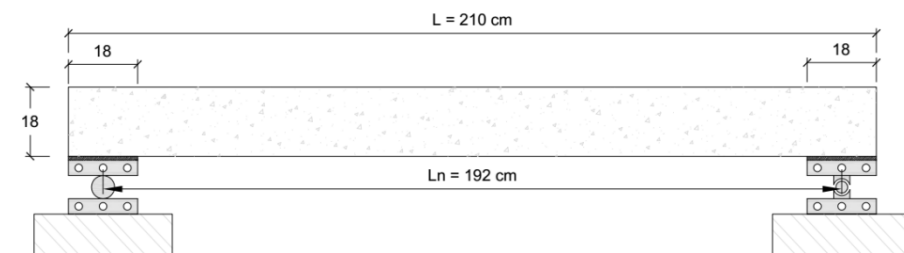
Poutre simplement appuyée (les dimensions sont en cm)
